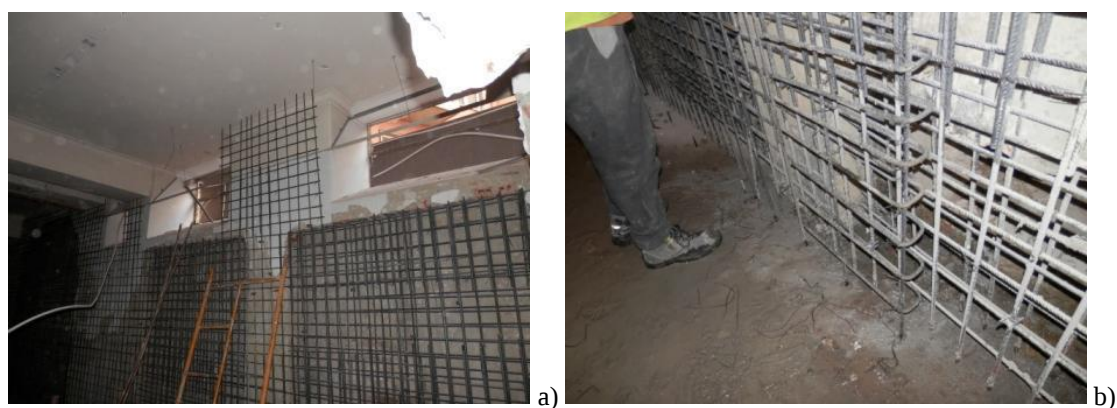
Parede periférica orientada a sul: a) armadura; b) detalhe da armadura
